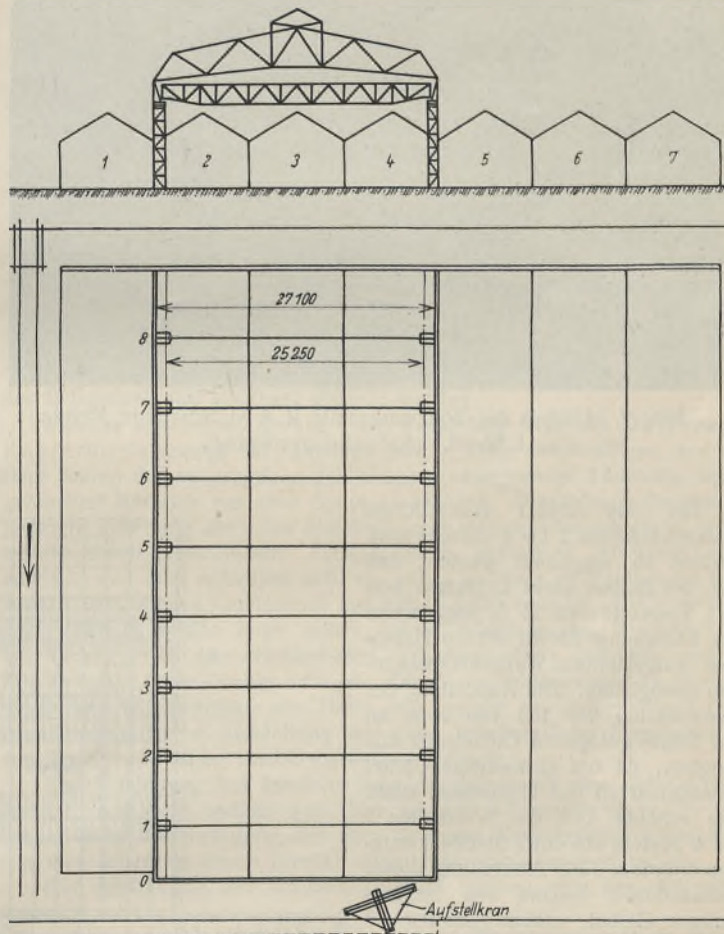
Umbau der Walzwerkshallen R. & G. Schmöhle, Menden i. Westf. (Grund- und Aufriß der neuen Halle.)
